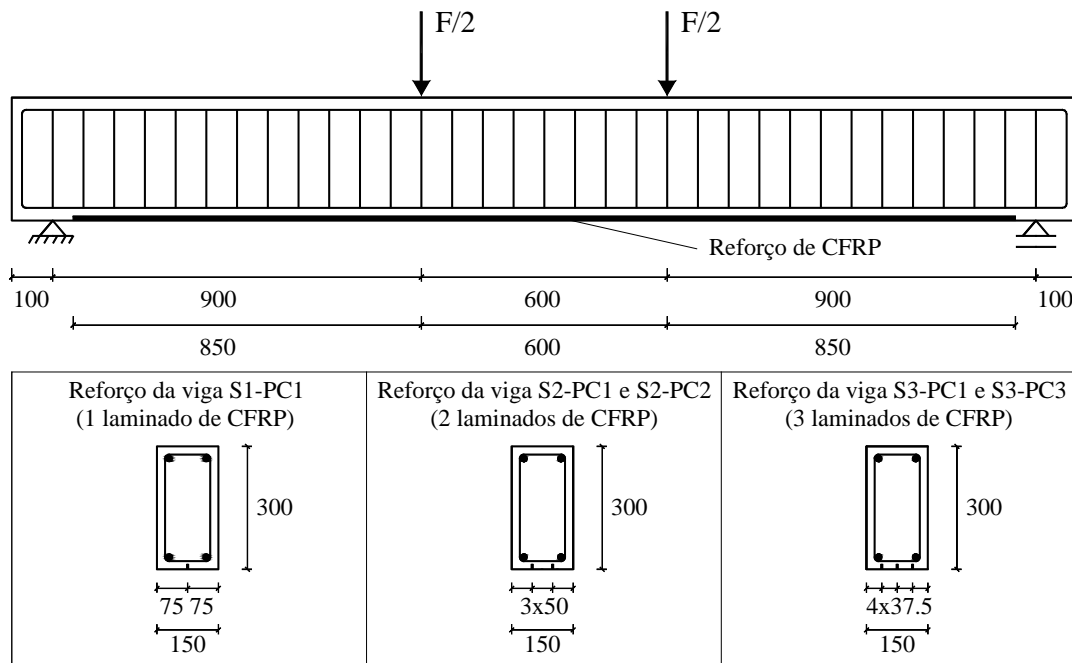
Soluções de reforço de CFRP adotadas (medidas em mm).
